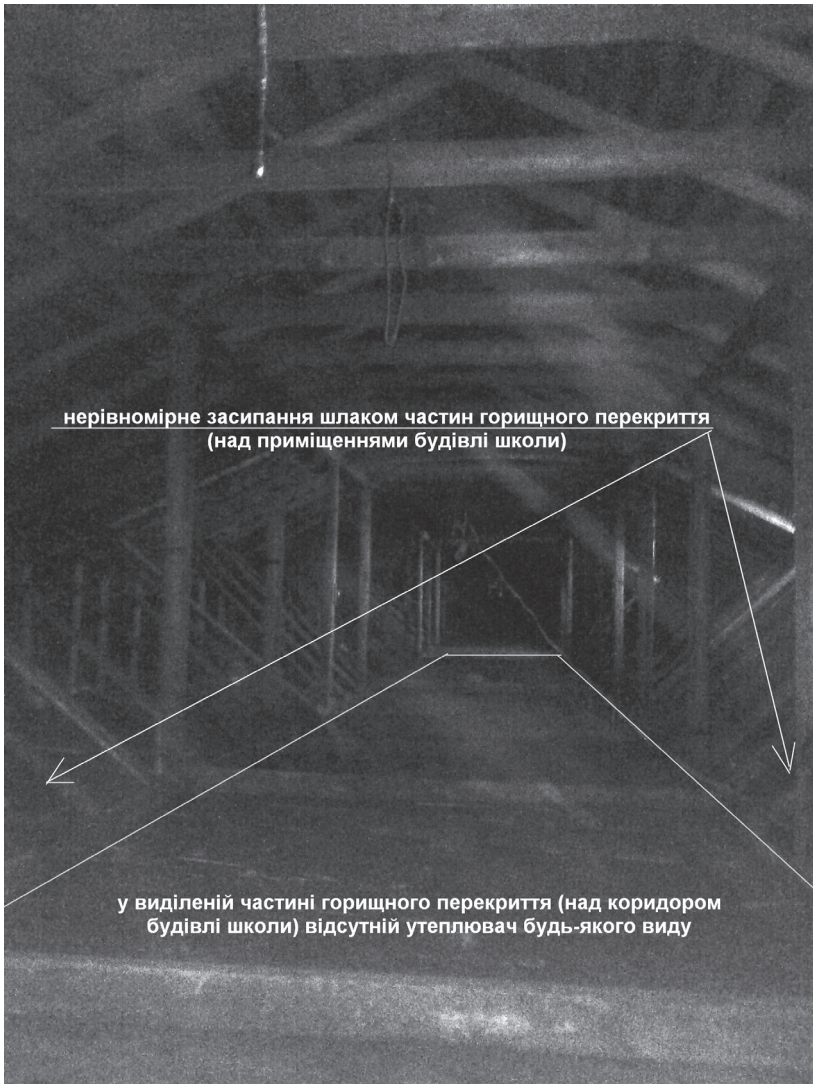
Горищне перекриття над різними частинами будівлі школи
